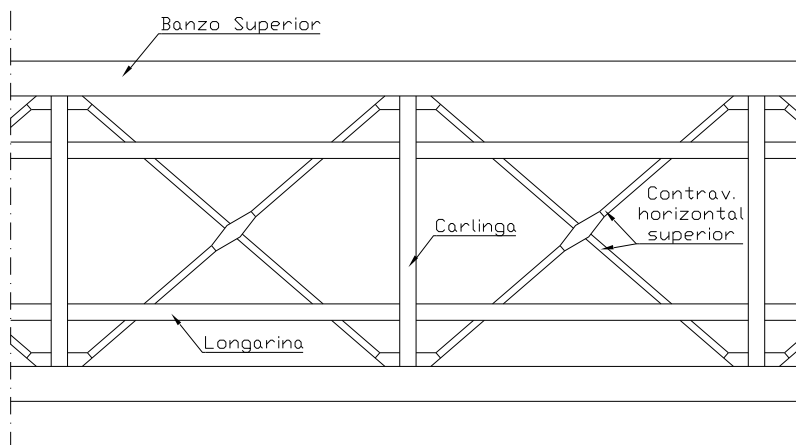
Vista superior do tabuleiro - Grelha constituída por longarinas e carlingas e respetivo contraventamento horizontal superior
